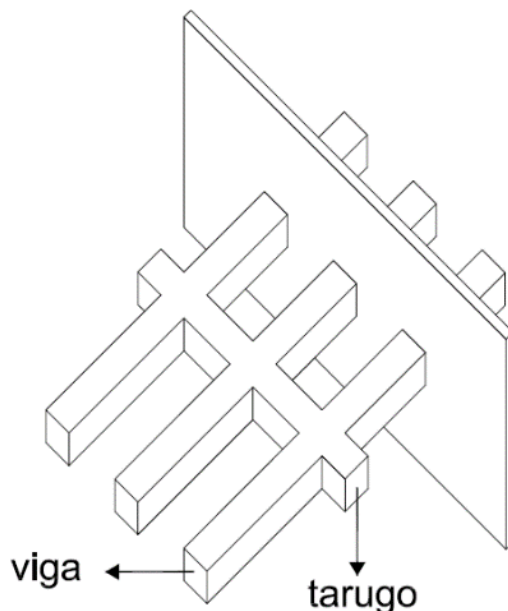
Pormenor do pavimento a descarregar na parede.
